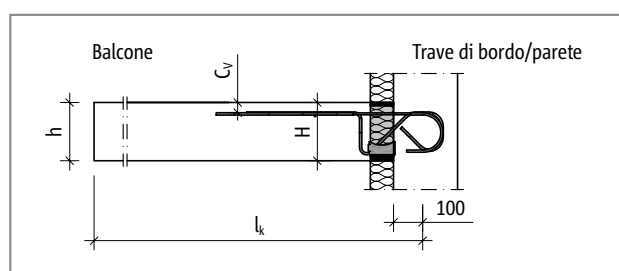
Schöck Isokorb® T tipo KL-O-M1 – KL-O-M7: schema statico
